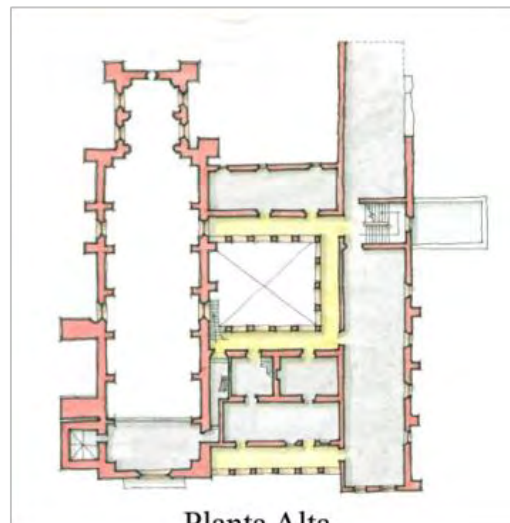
Tochimilco, Pue. Ex convento La Asunción. Planta arquitectónica. TMH Plumón sobre sketch
